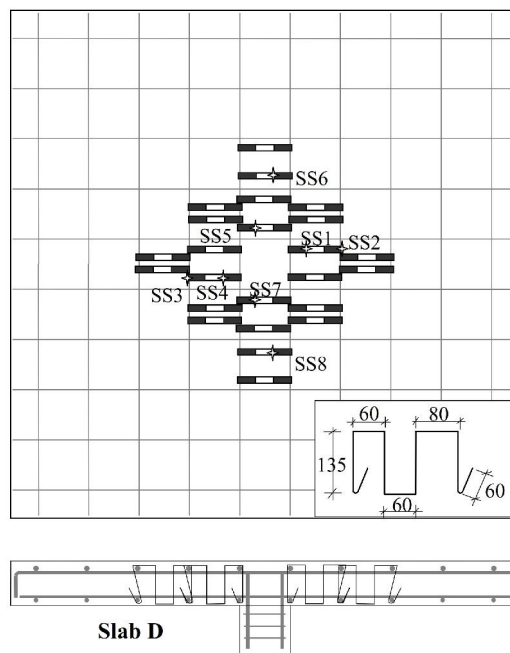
Pormenor das armaduras de punção da laje PSS-D [54].
